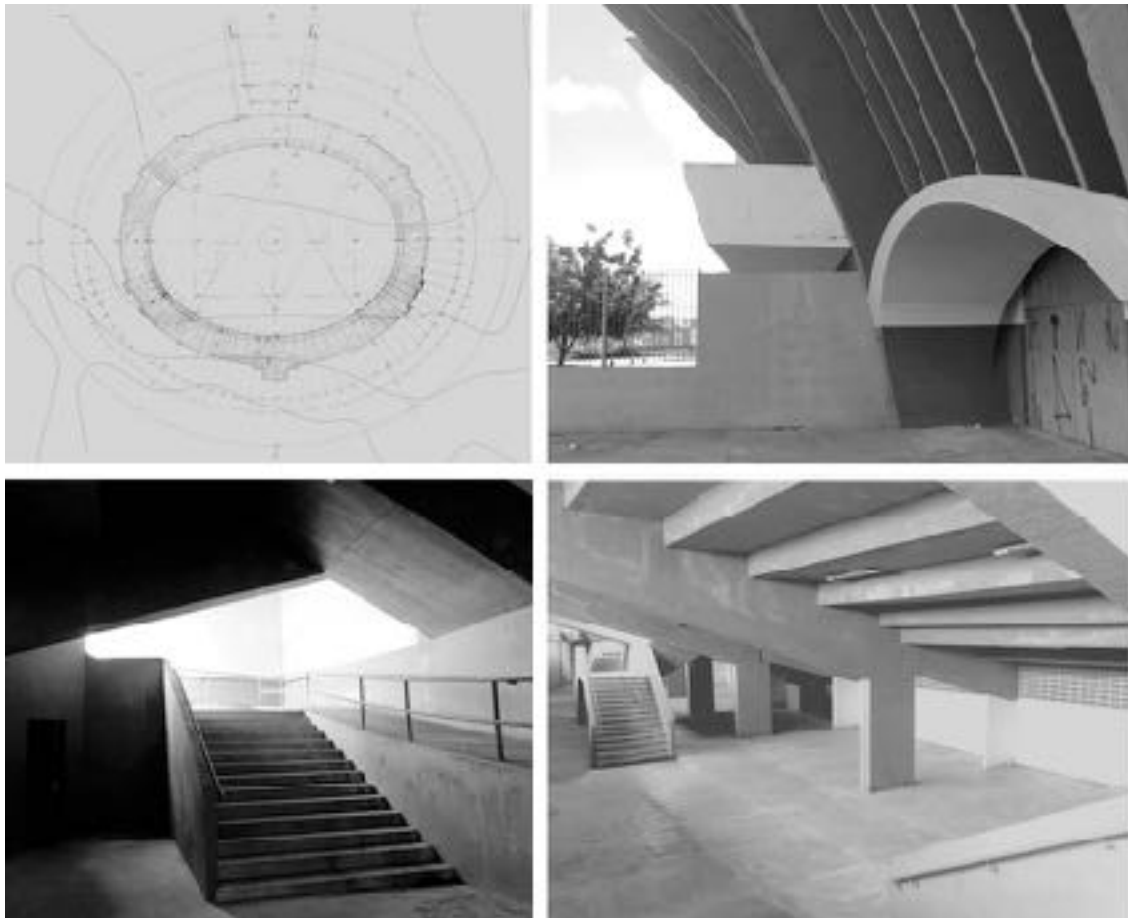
Esquema da planta e detalhes estruturais e interior.
